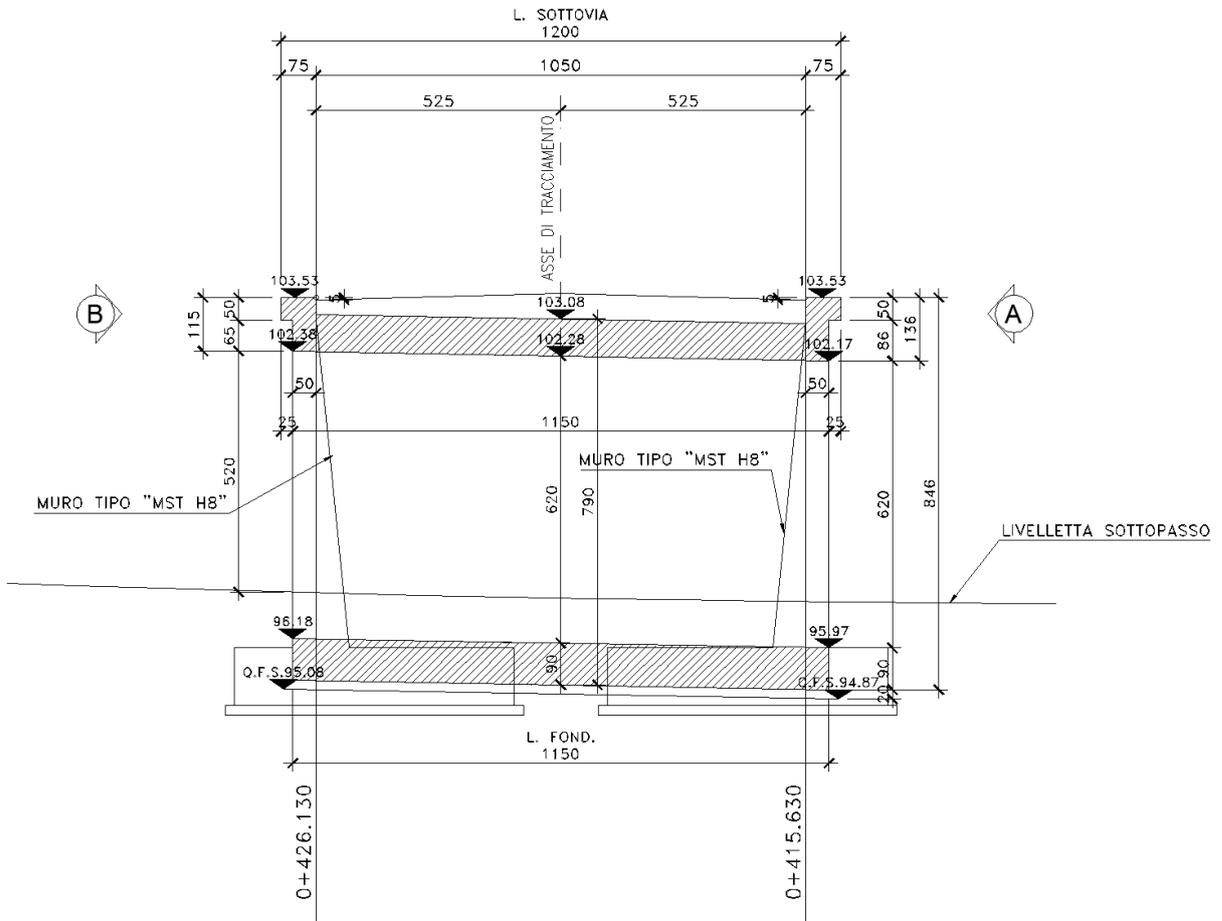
Sezione Longitudinale in asse sottopasso
